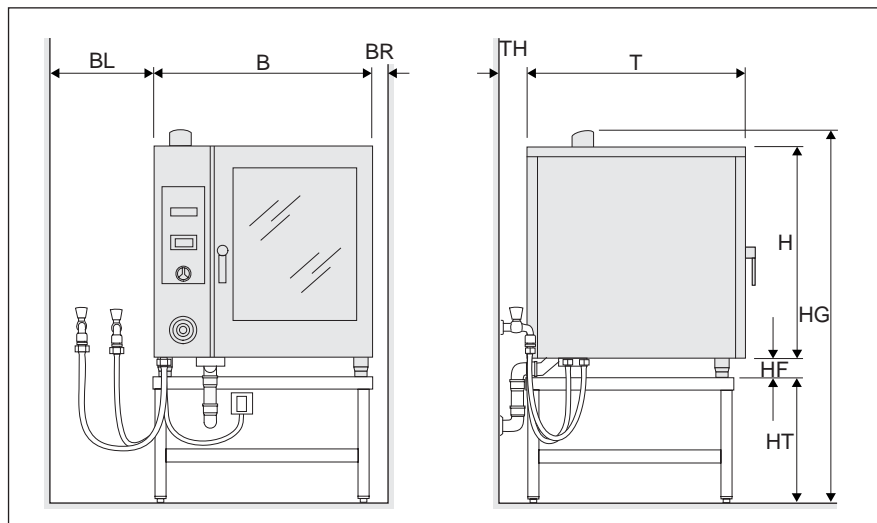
Dimensões de instalação do vaporizador combinado 615/620 e 115/120
